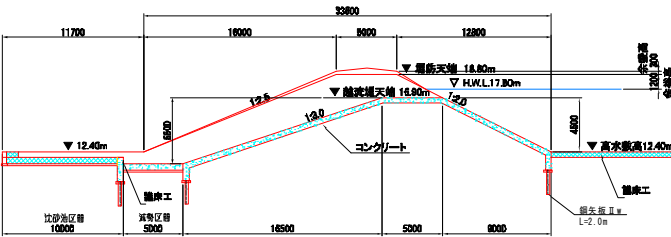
遊水地①（5.6k 左岸）越流堤横断面図
